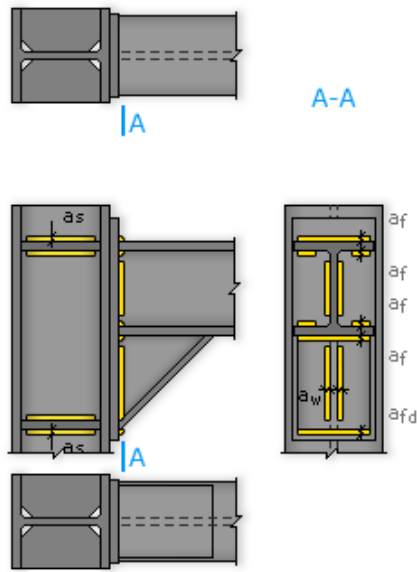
Soldaduras presentes na ligação entre o pilar e a travessa
